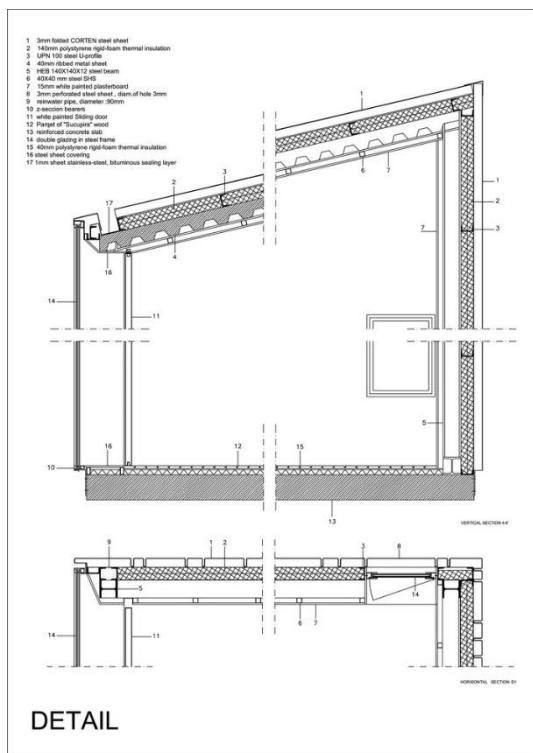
Detalle constructivo de la ampliación con el canalón integrado [Plataforma Arquitectural]
